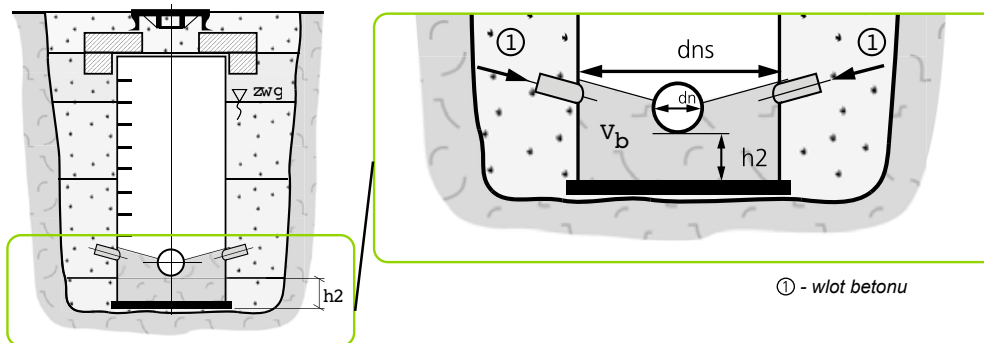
c. Posadowienie studzienki na płycie fundamentowej
